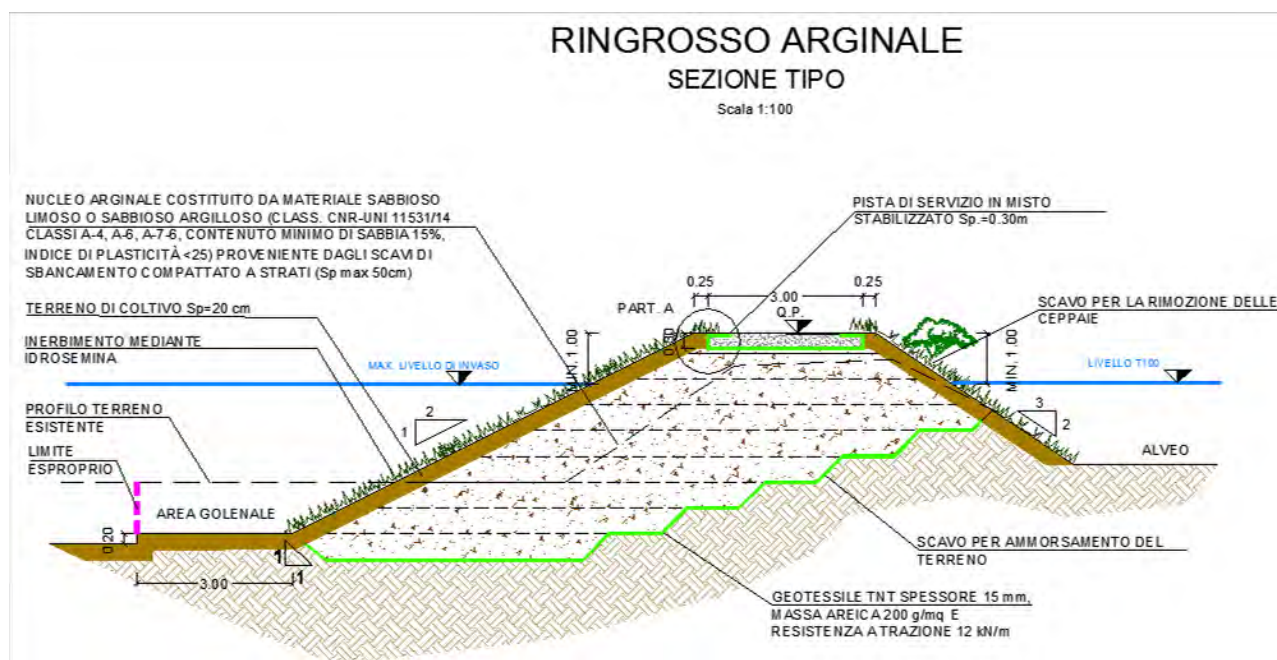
Sezione trasversale tipo del manufatto di restringimento delle aree golenali
